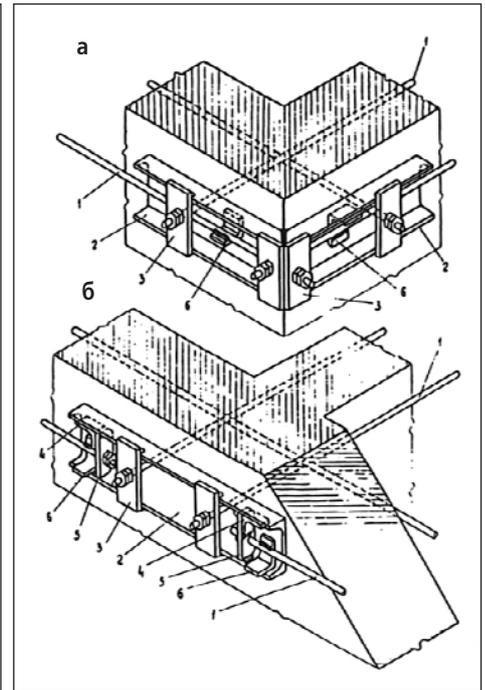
Схема усиления стен здания с помощью парных стальных стяжей: а – на углу здания, б – на пересечении наружной стены с внутренней; 1 – тязь, 2 – обжимной элемент, 3 – опорная накладка, 4 – опорный угольник, 5 – опорная косынка, 6 – угольник для защиты тязя от скручивания, 7 – накладка для увеличения жесткости обжимного элемента
